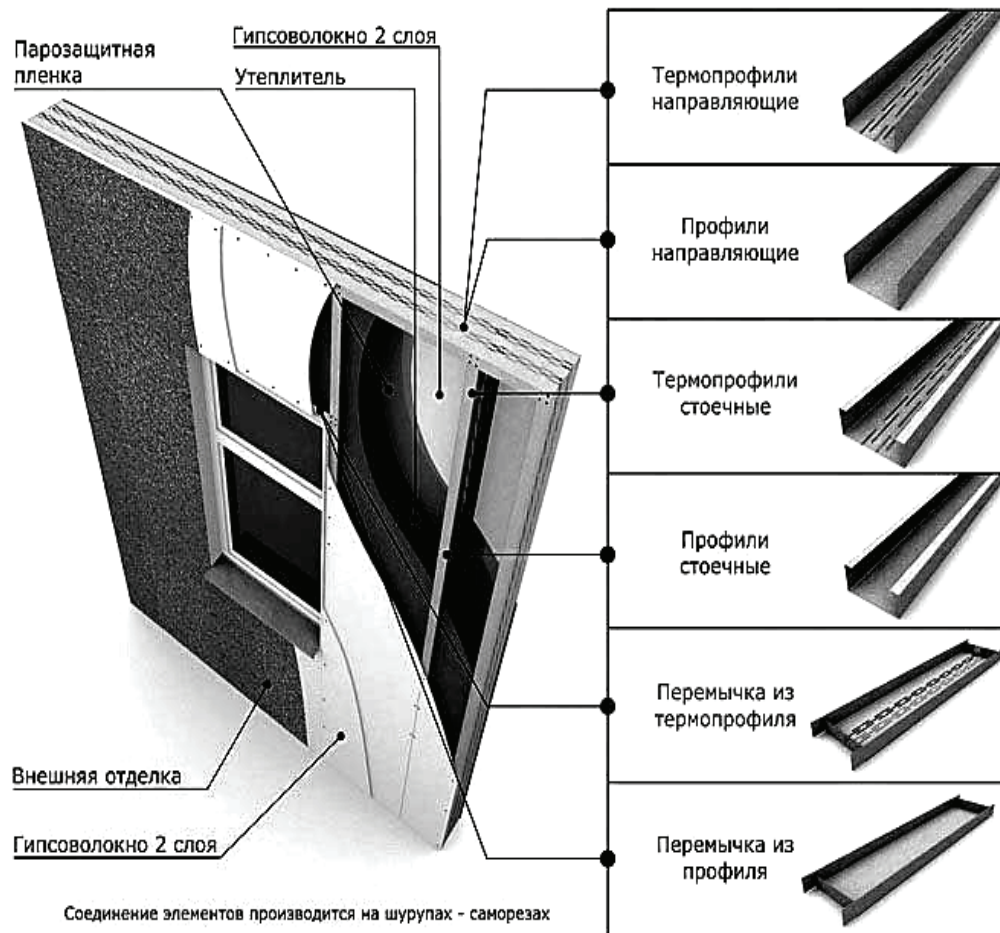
Схема конструкции стеновой панели при возведении зданий ЛСТК.
